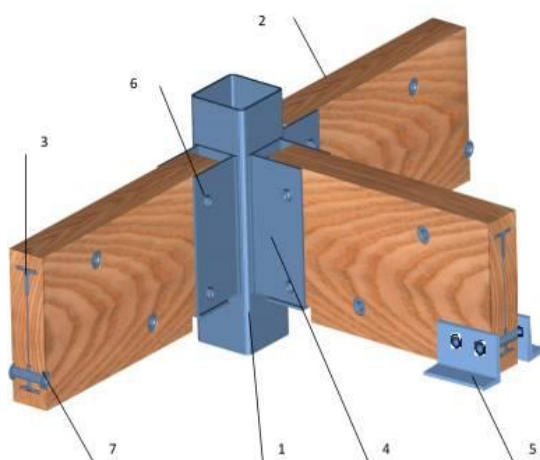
Узел соединения стойки и балок: 1 – стойка; 2 – балка; 3 – сердечник; 4 – кронштейн опорный балки; 5 – кронштейн опорный панели; 6 – болт; 7 – нагель трубчатый
